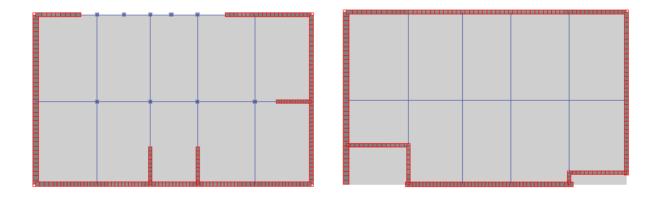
Planta primer y Segundo piso, Banco Estado.
